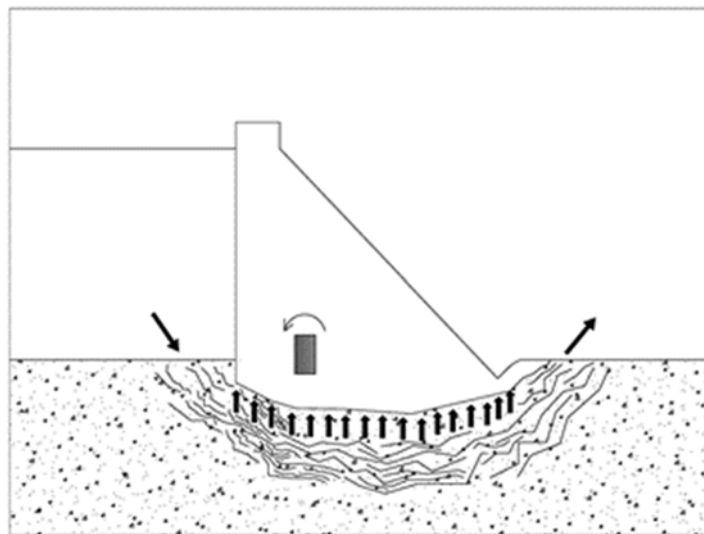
Ilustrasi keruntuhan hidraulik pada fondasi bendungan yang dimulai dari tubuh bendungan
